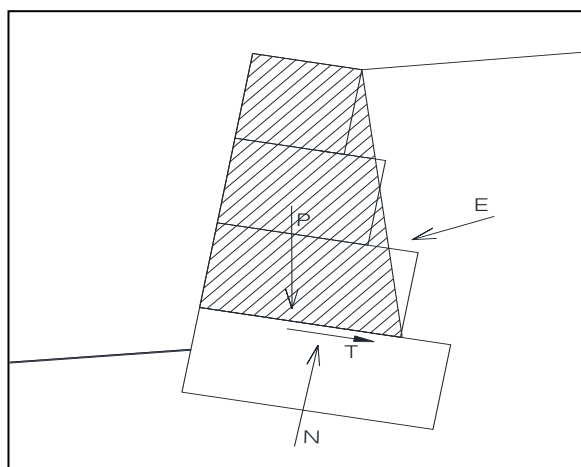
Esquema de fuerzas internas actuantes en el muro gavión.
